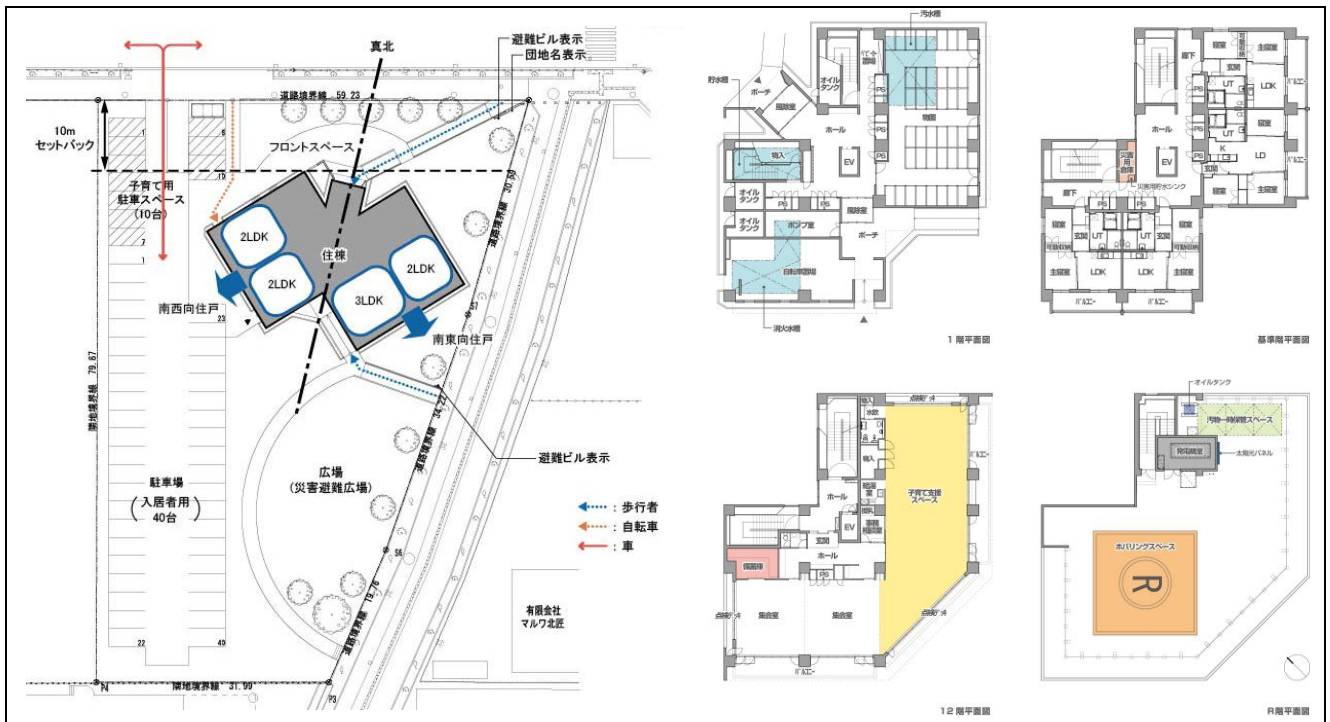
釧路市道営住宅であえーる幸団地（配置図及び各階平面図）
